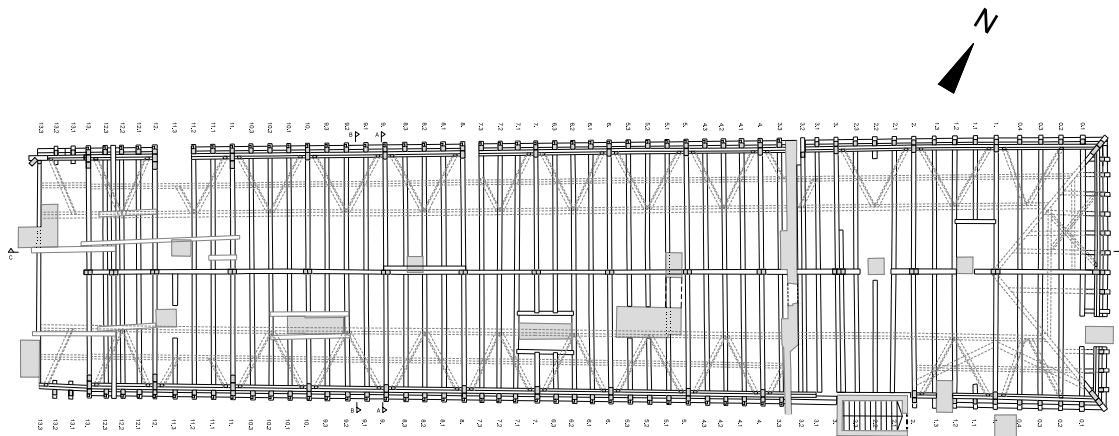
Grundriss Dachwerk Nordwesttrakt
